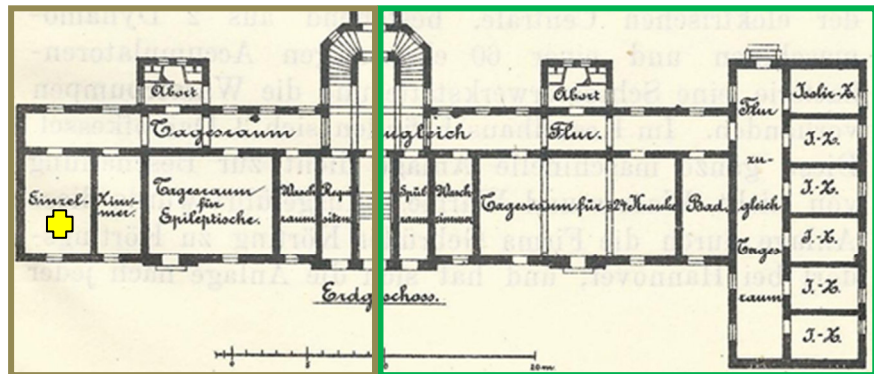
Grundriss Haus Frauen-C mit vermutlich Abteilung D (brauner Rand).
